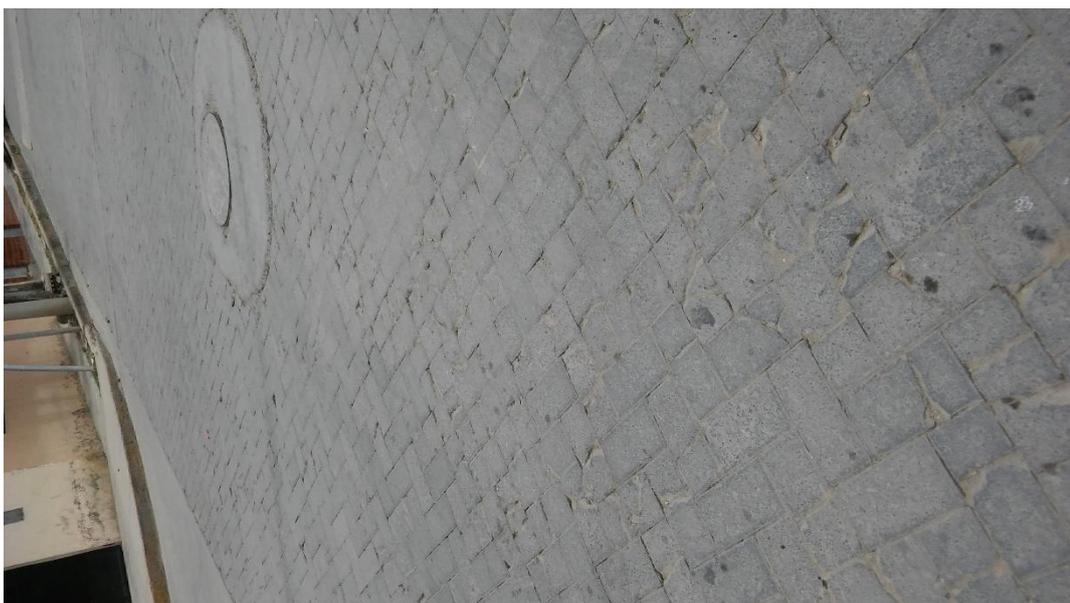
Desgaste Superficial y Fracturamiento en la Calle Zarumilla
